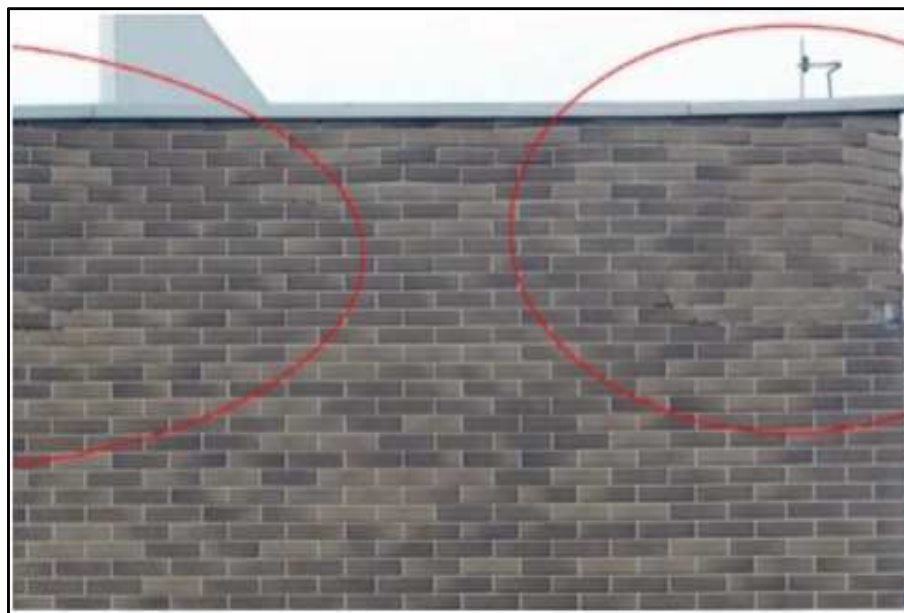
Má aplicação de revestimento em fachada propicia infiltrações
